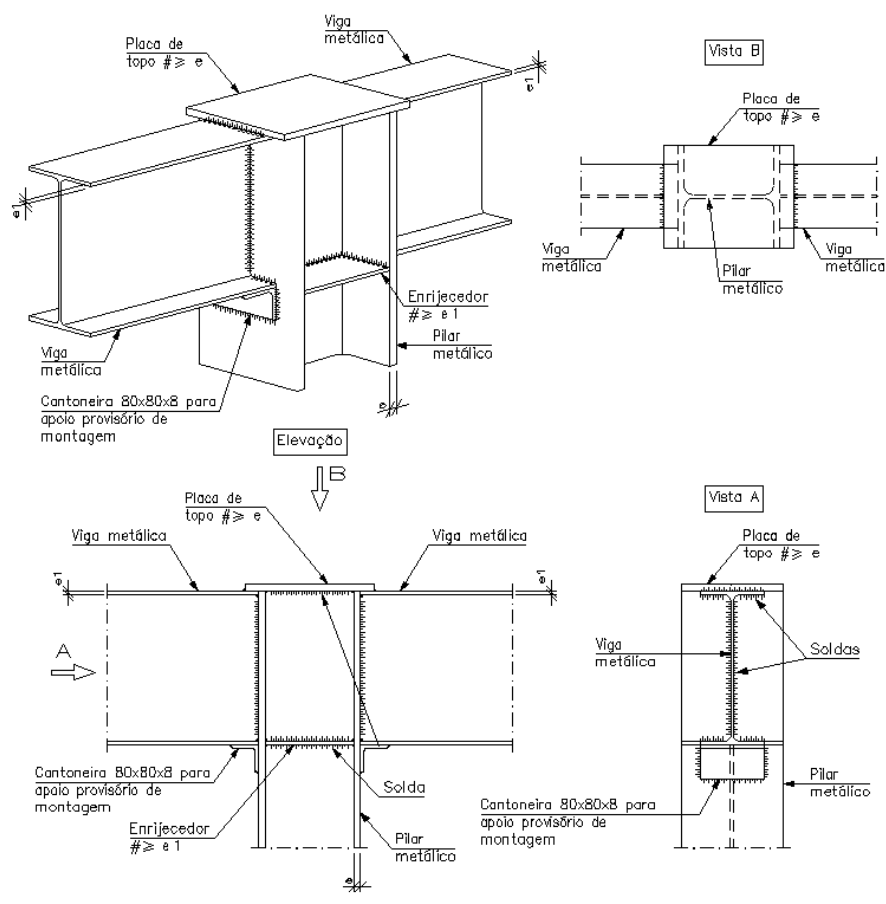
Ligação semi-rígida em linha de pilares, de viga-pilar com viga-pilar
